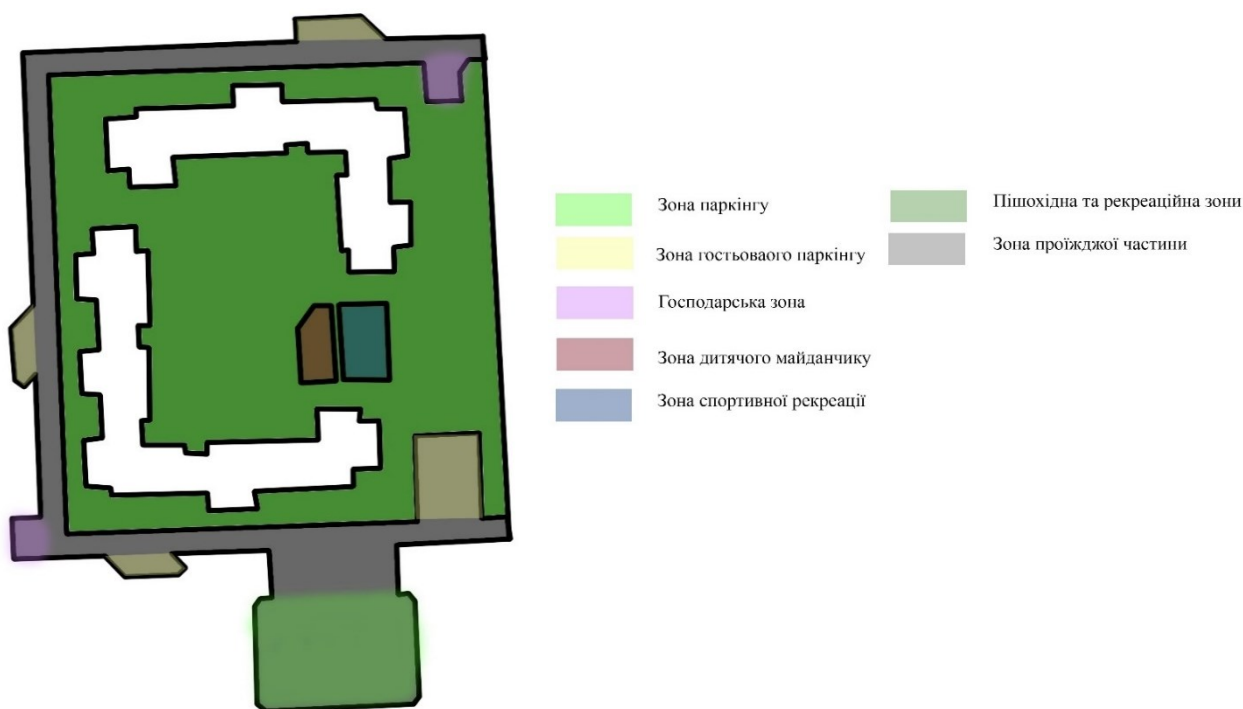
Схема функціонального зонування генерального плану
